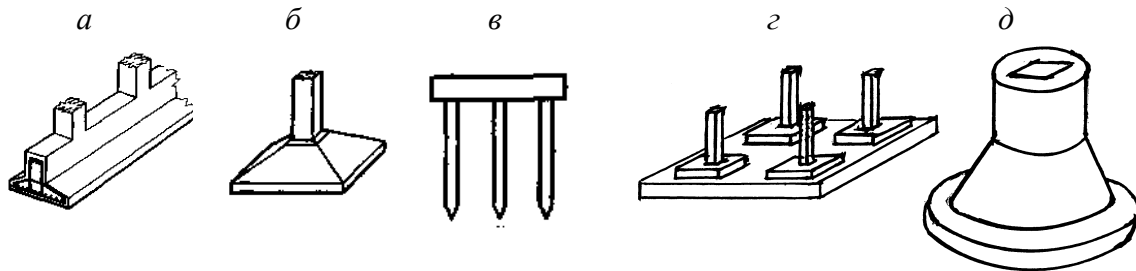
Основні типи залізобетонних фундаментів:
